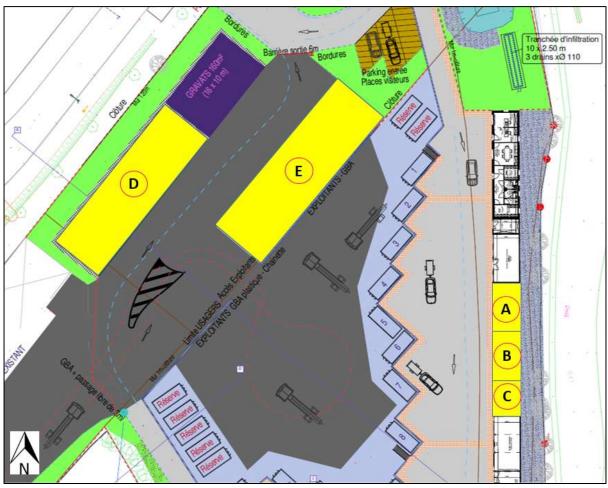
Plan de masse avec localisation des dispositions constructives particulières
